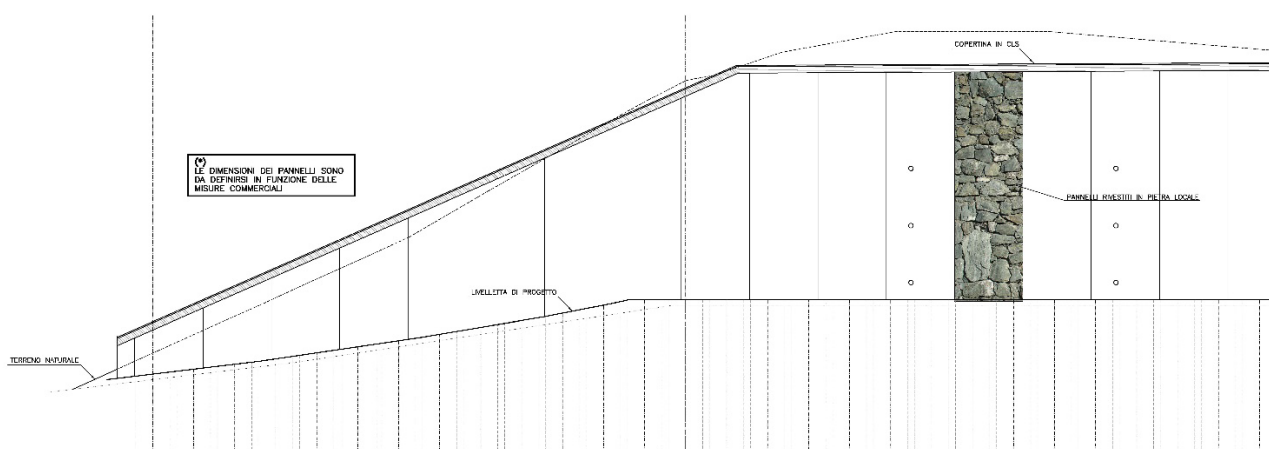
Prospetto di una paratia con rivestimento in pietra e copertina
